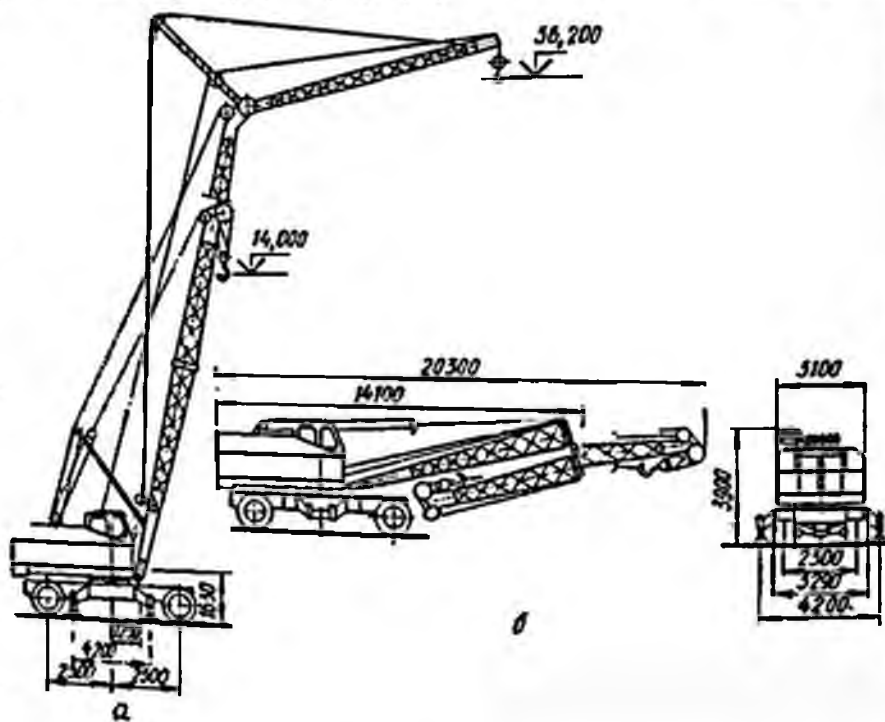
Пнемоколісний кран КС-5363.
